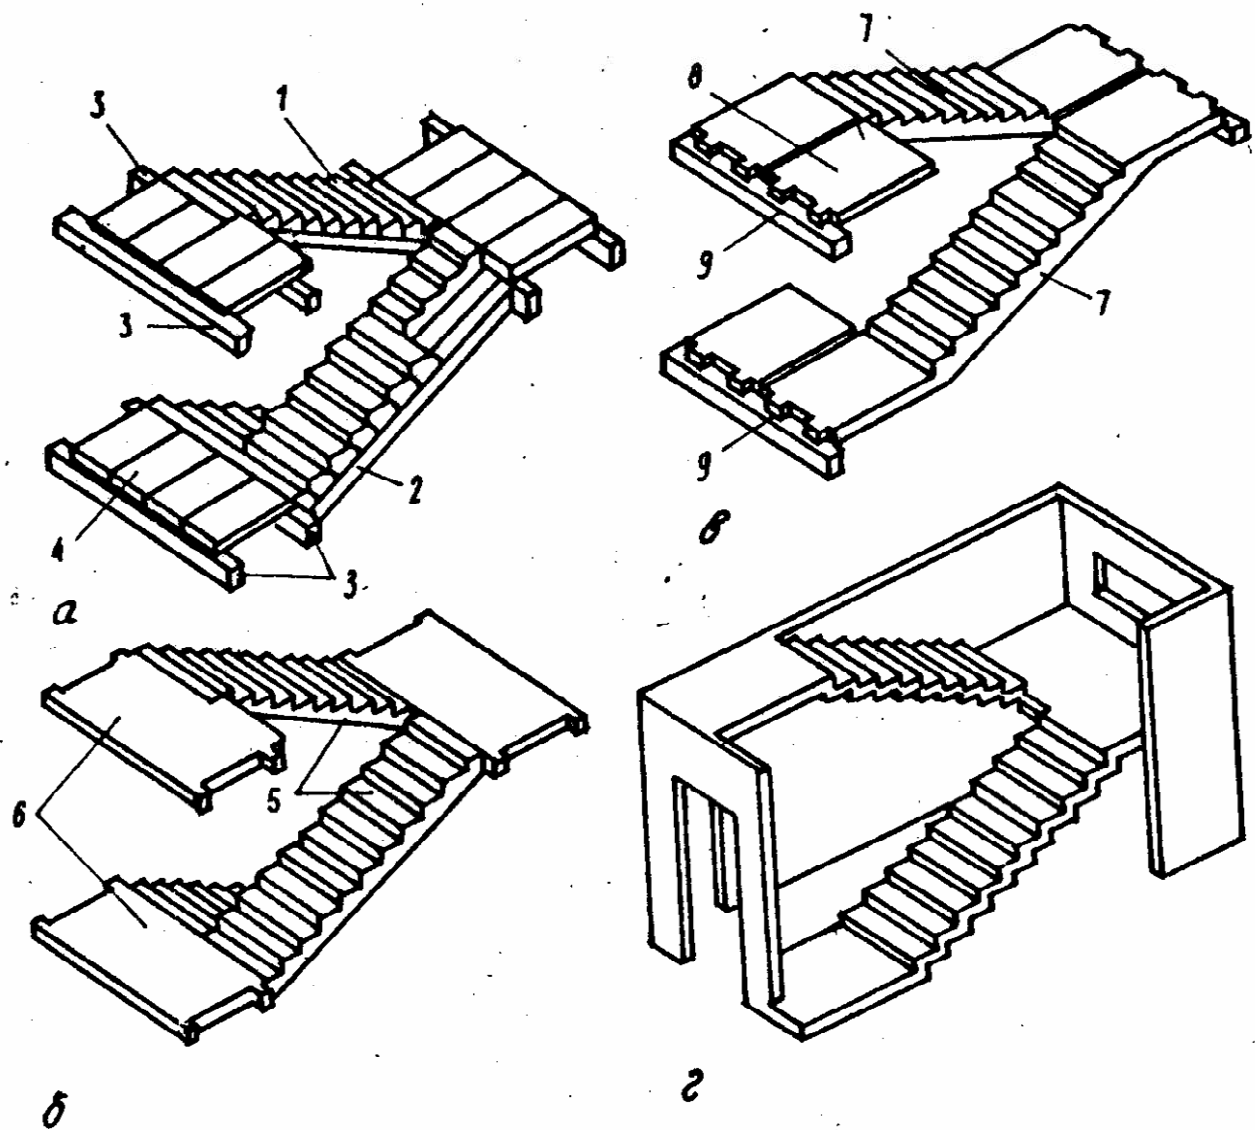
Схеми збірних залізобетонних сходів:
